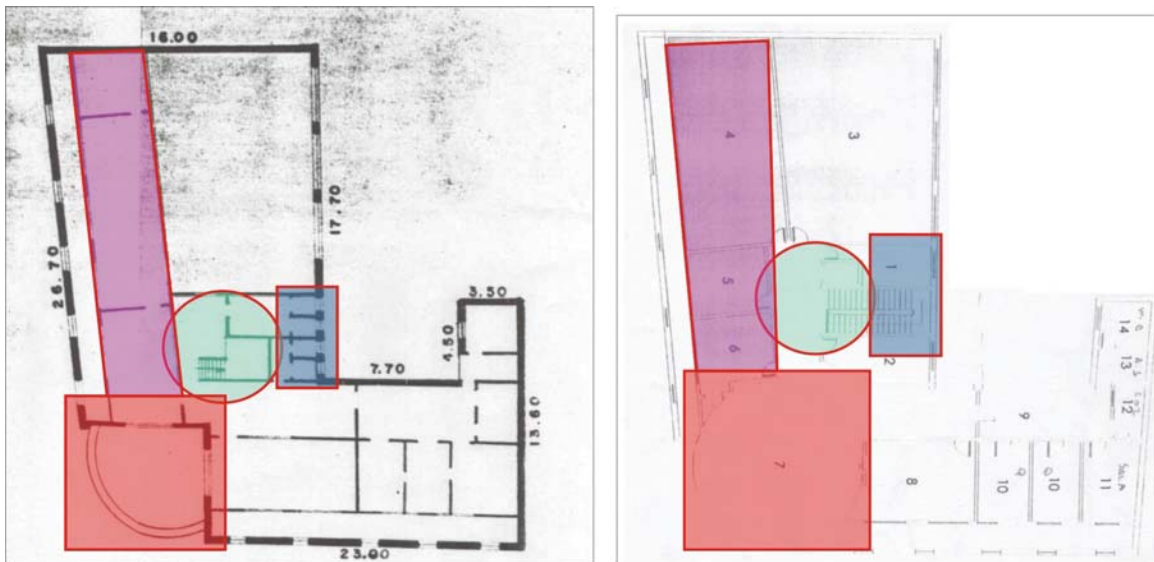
Planta do 3 pavimento do Instituto de Eletrotécnica e da Escola de Comunicação, respectivamente.
